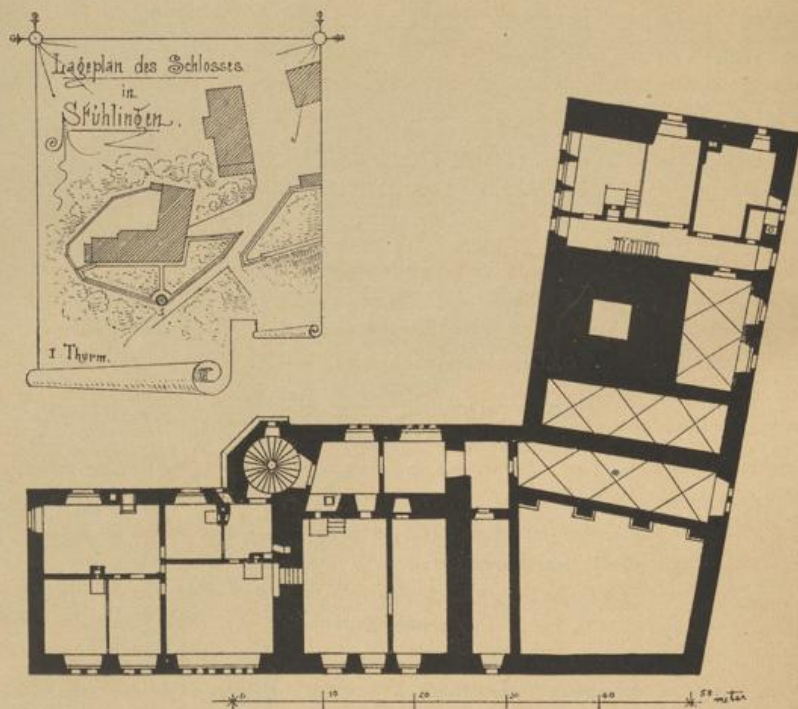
Stühlingen. Grund- und Lageplan des Schlosses.
